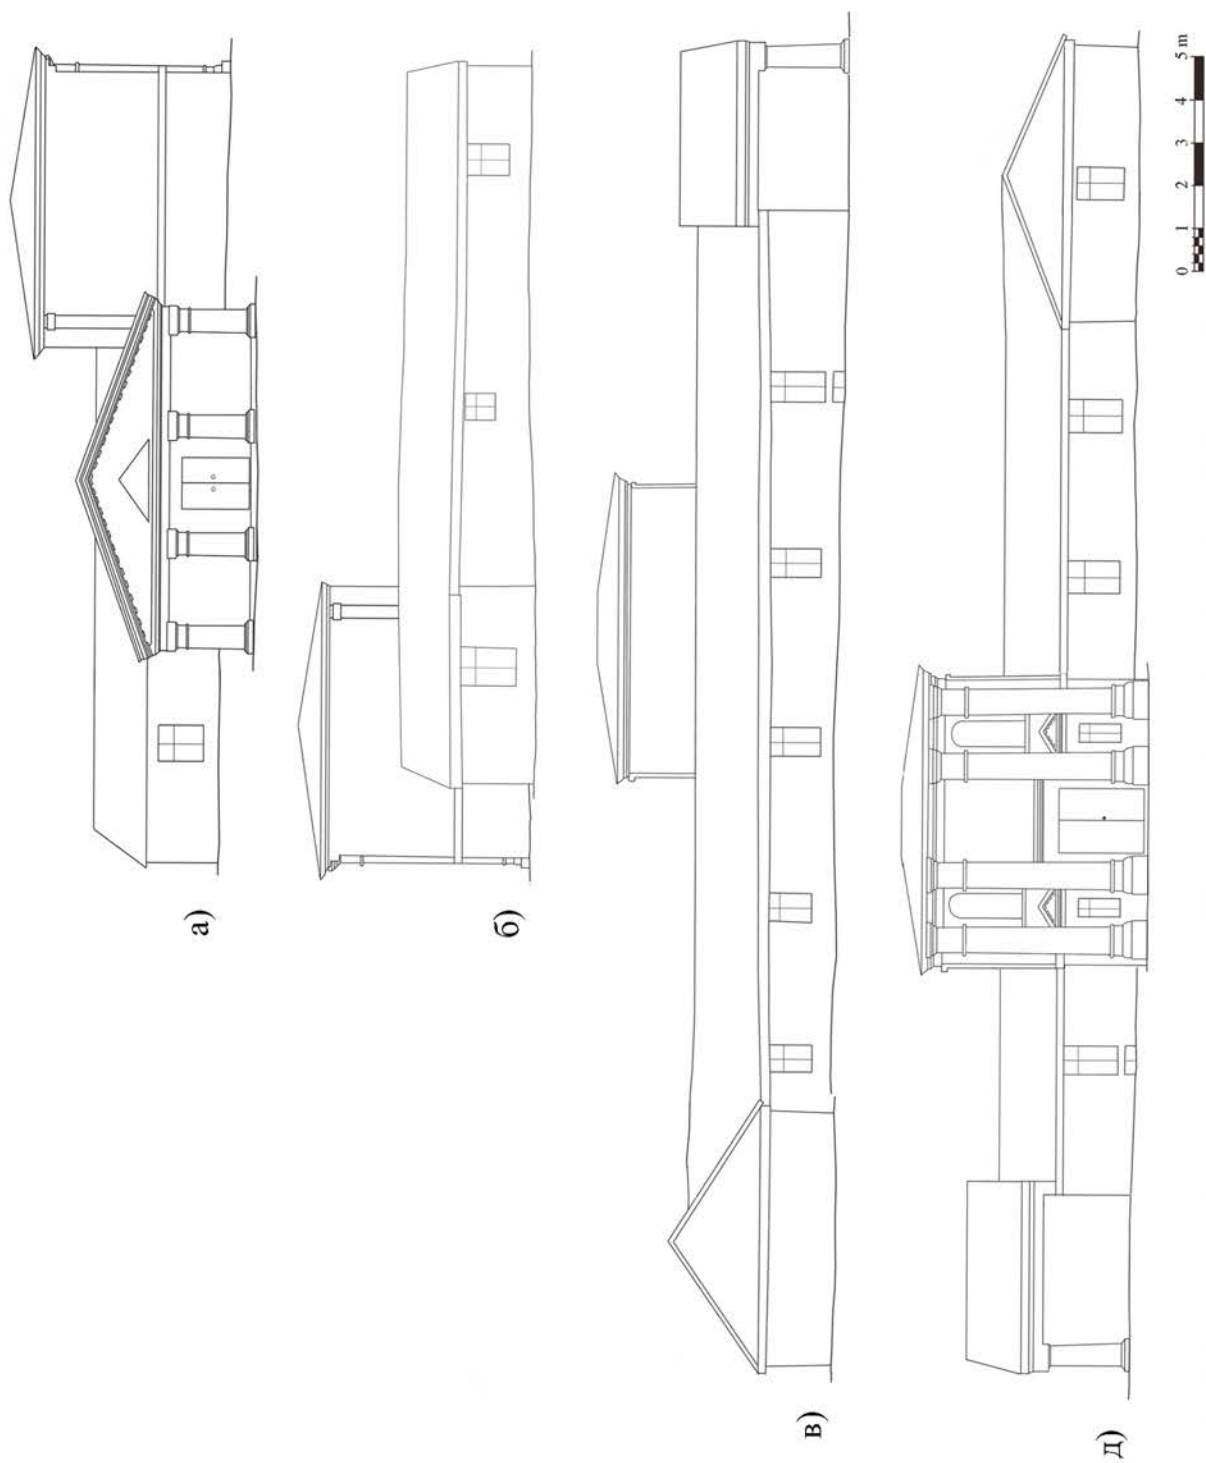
Вірменський храм Аккермана. Розгортка фасадів. а) західний фасад; б) східний фасад; в) північний фасад; д) південний фасад.
